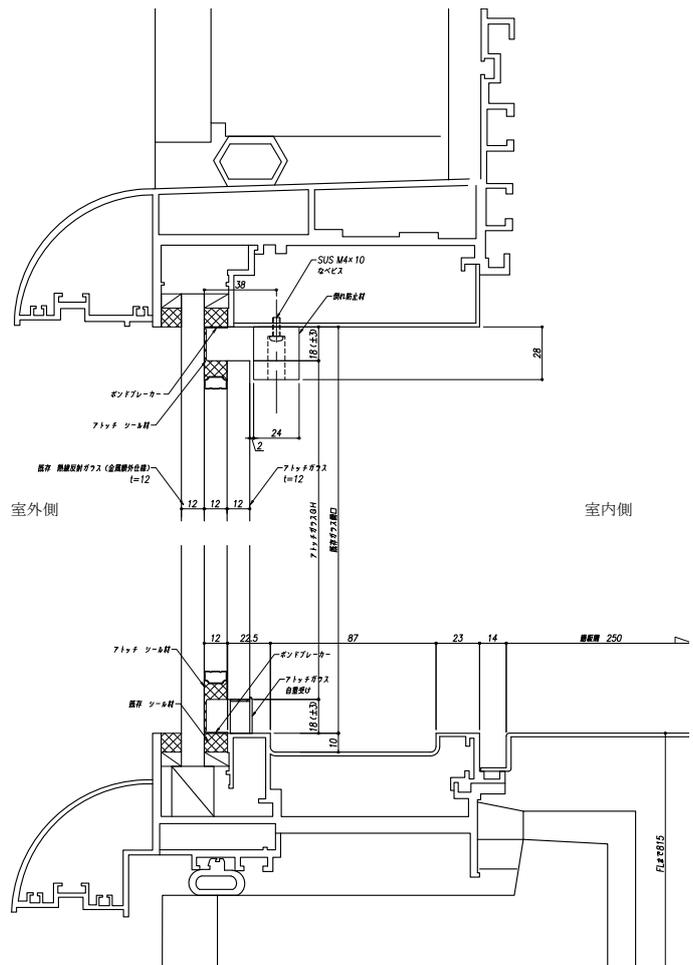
建物 B ガラス追加断面施工図 (縮尺: 1/4)
